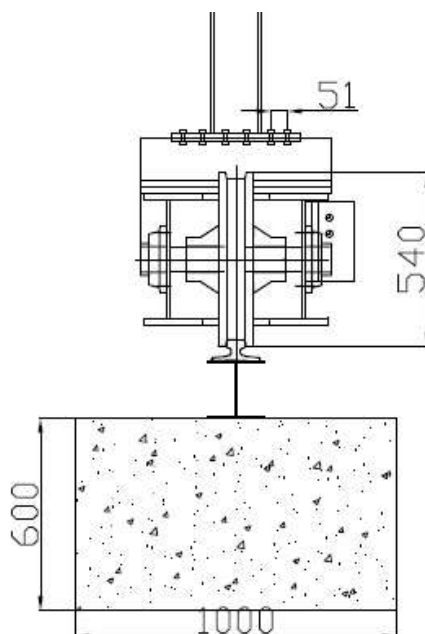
Carro móvil del pórtico metálico y sección de la zapata.
